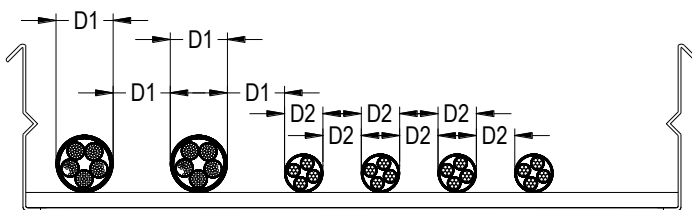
1 Espaciado entre cables en áreas clase II división 2
